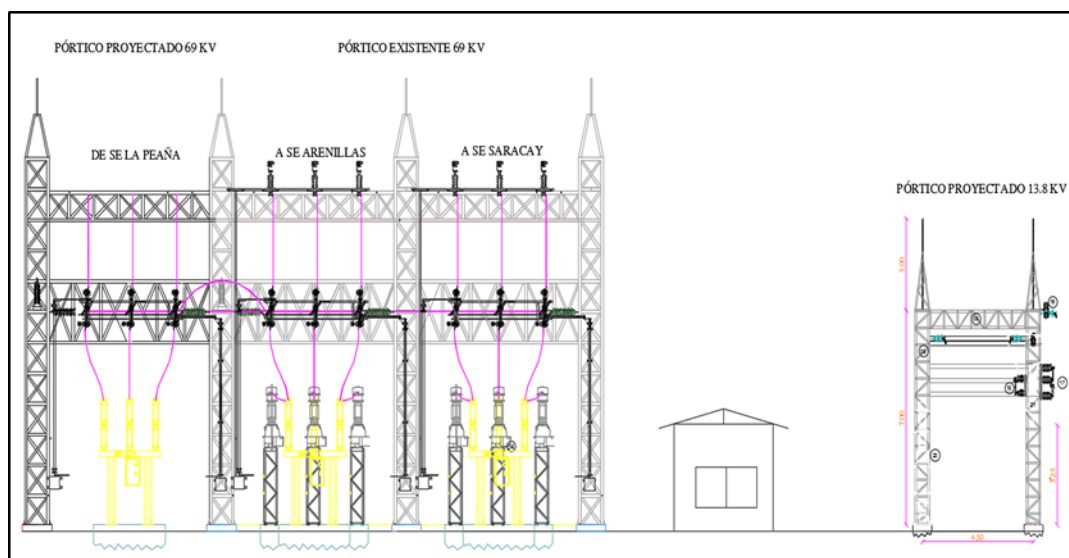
Vista frontal de pórticos existentes en la subestación La Avanzada.
